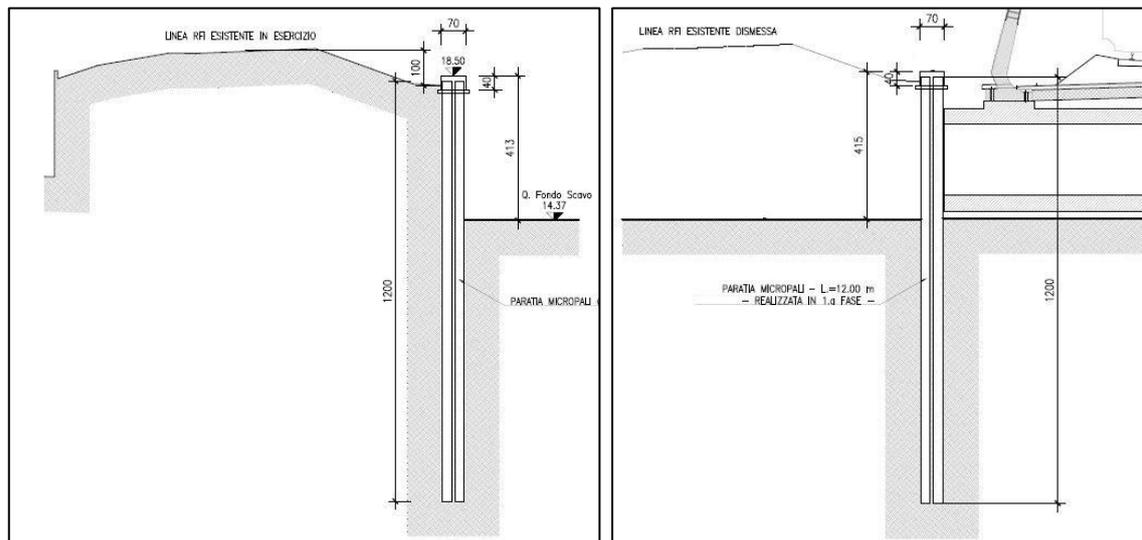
Sezione trasversale in prima fase (sinistra) e seconda fase (destra)
